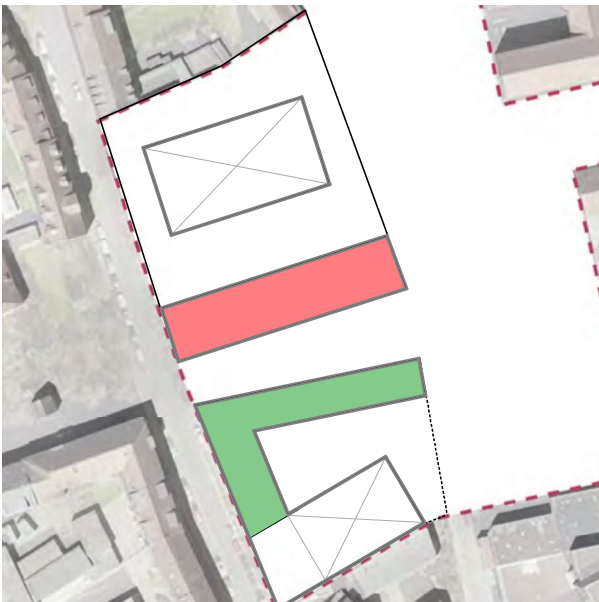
Grundriss OG2 Großer Hof V1
